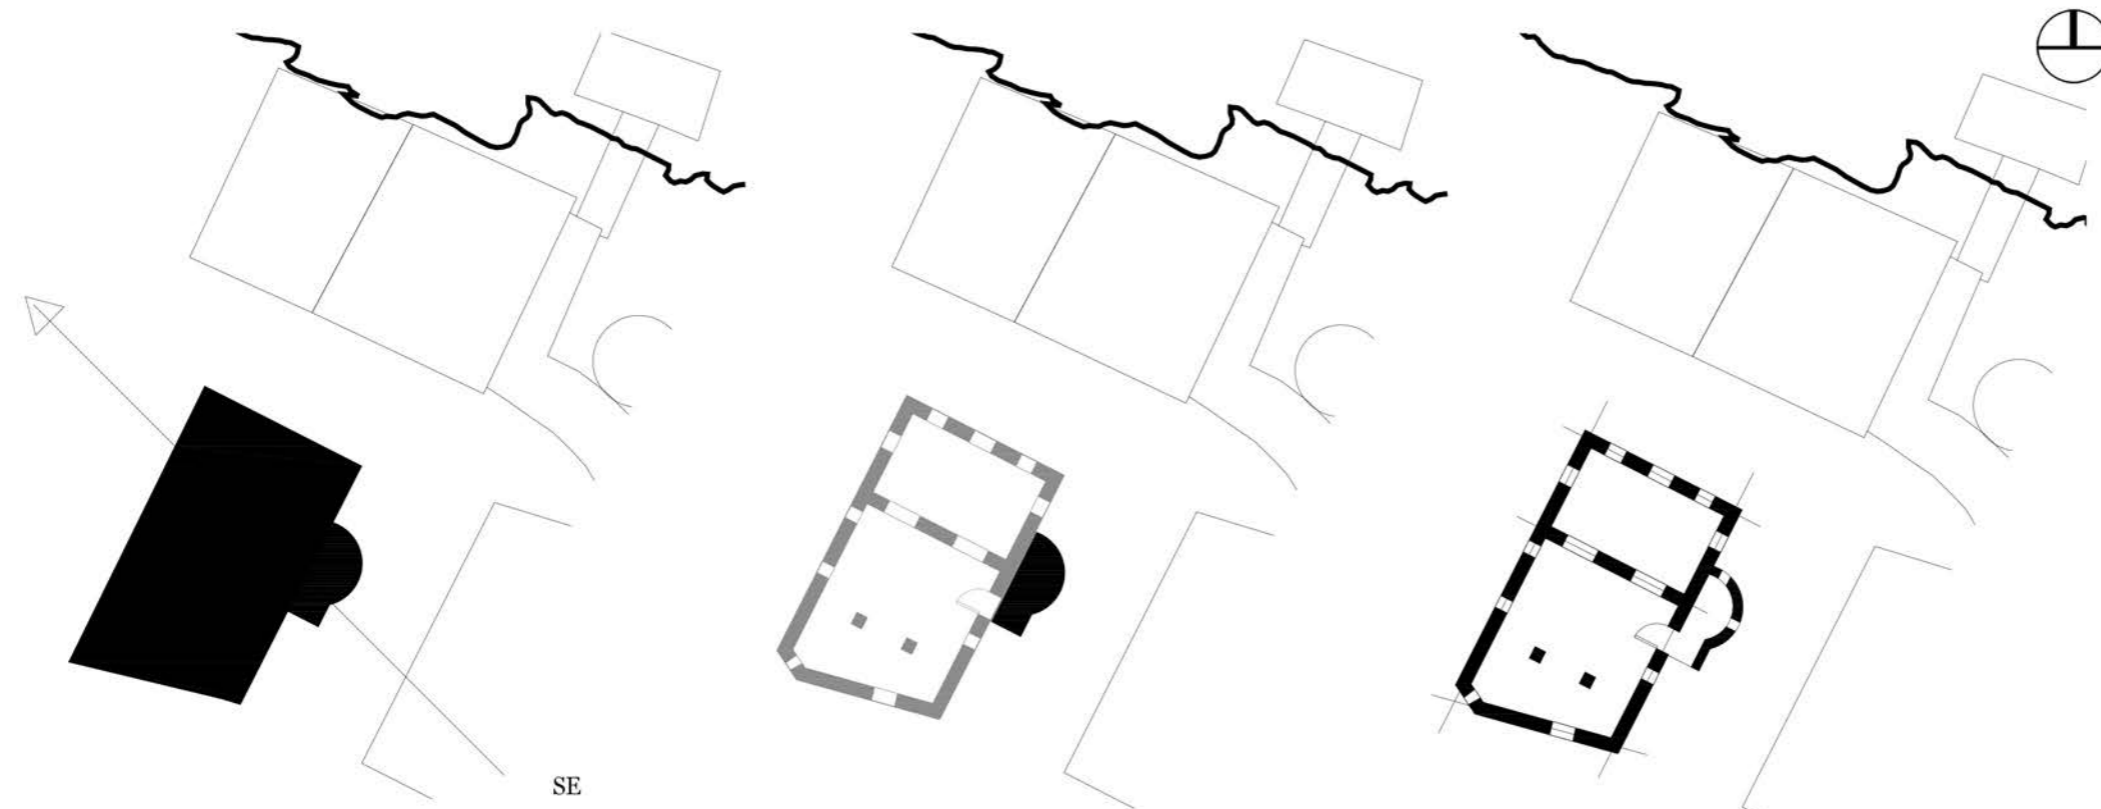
Análisis de la Casa de piedra de Gus Angermeyer. Los planos pueden ser observados en la figura 33 en el Capítulo 1. Elaboración propia.
